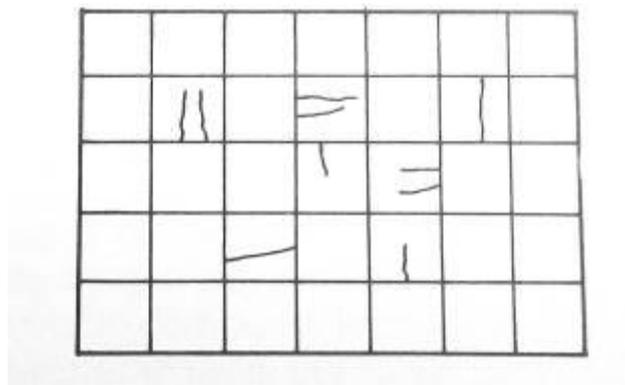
Fissuras de retração numa viga de concreto armado
